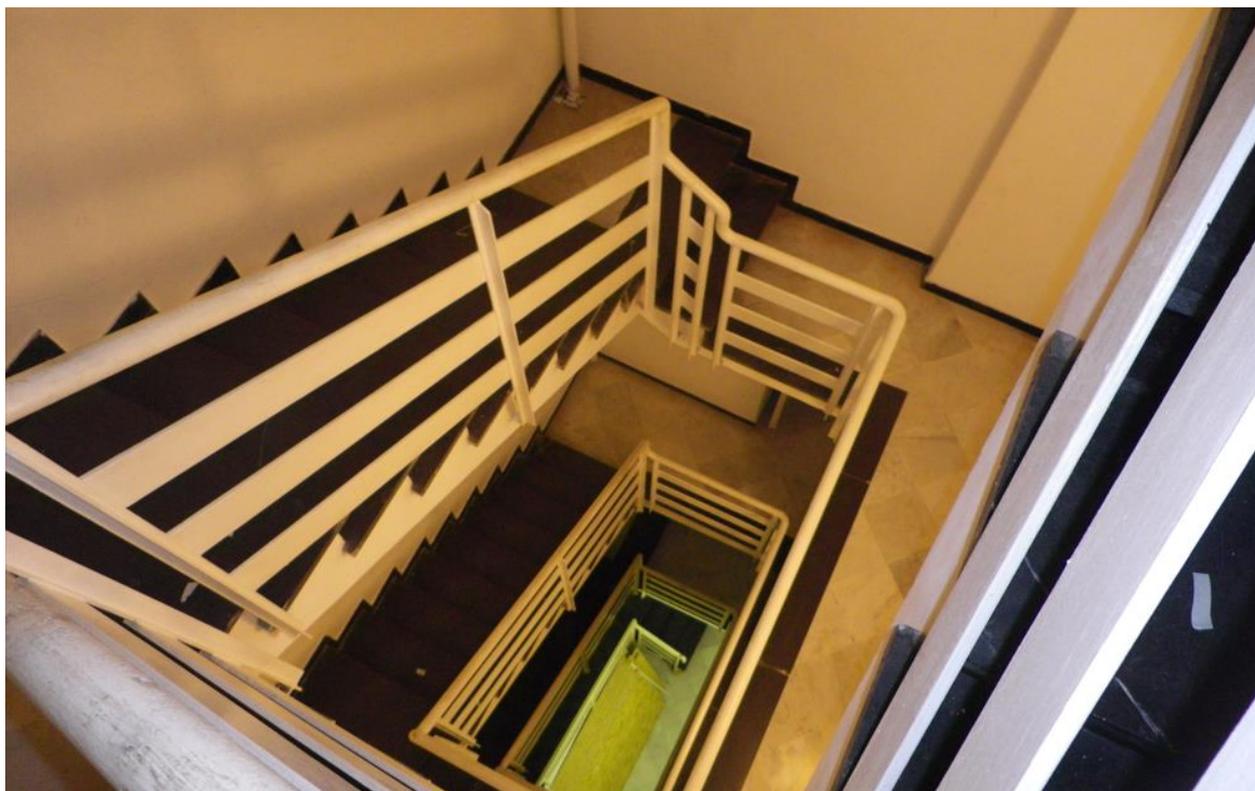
Interni dettaglio sviluppo scala di servizio vista da ultimo ballatoio
